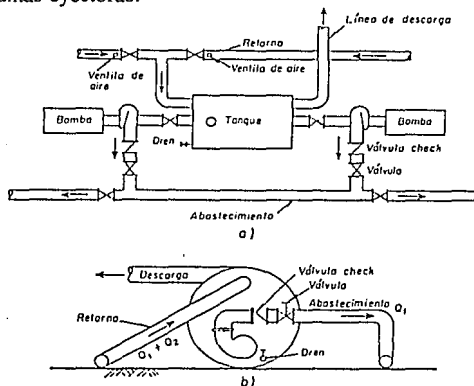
Estación de bombeo típica para sistemas eyectores a) Planta b) Vista lateral
